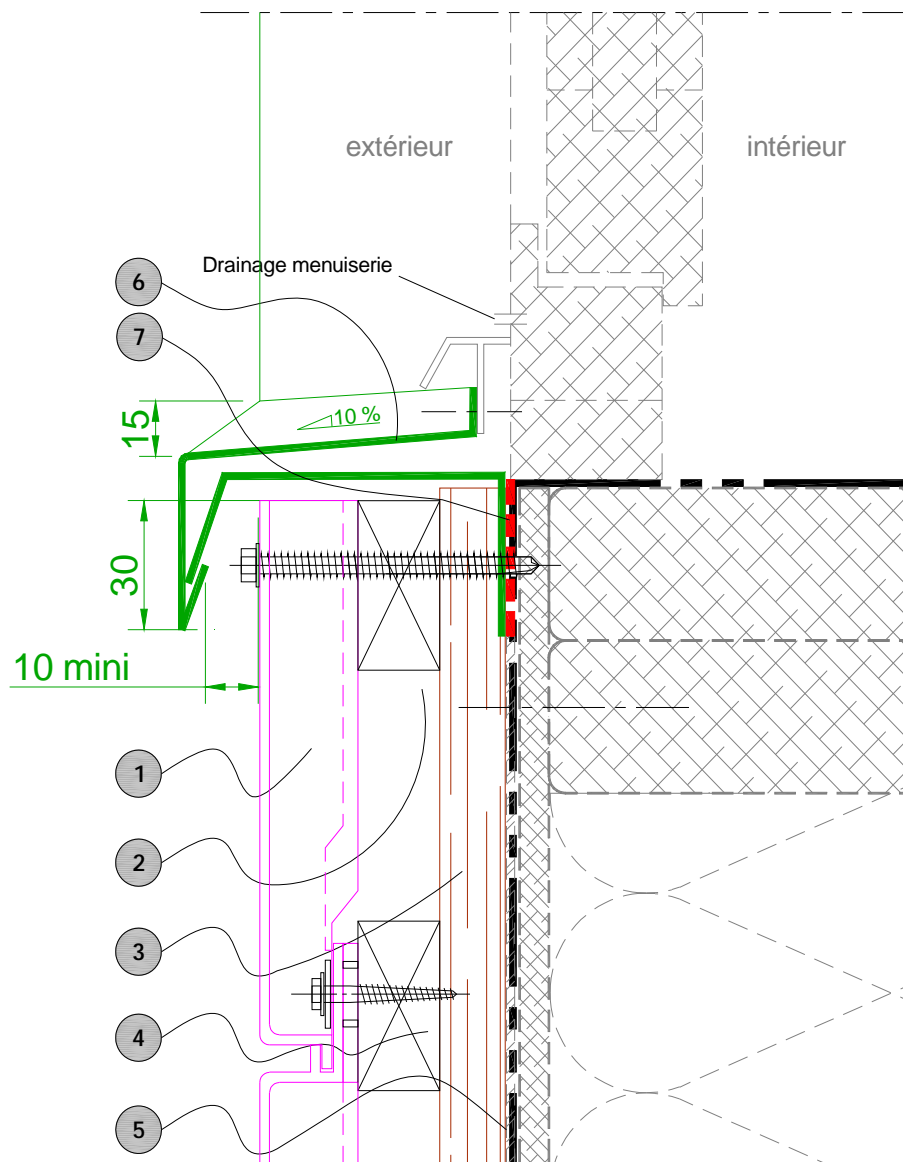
Détail de principe sur étanchéité et recouvrements
